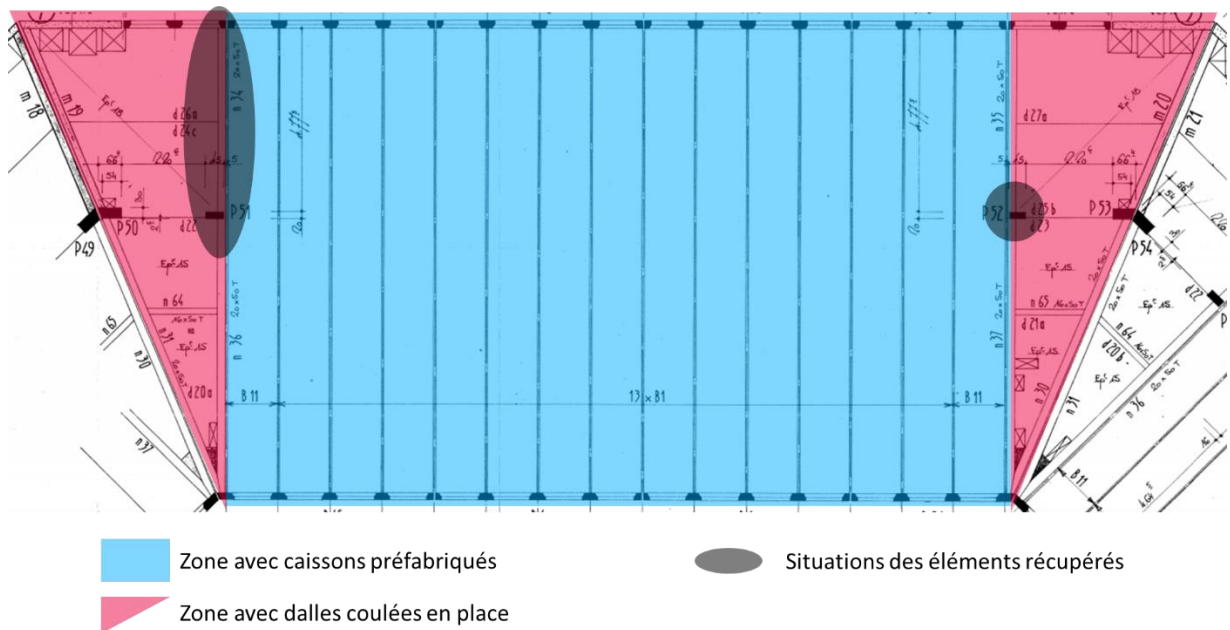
Vue en plan du plancher du bâtiment déconstruit sur le chantier de Lyon
